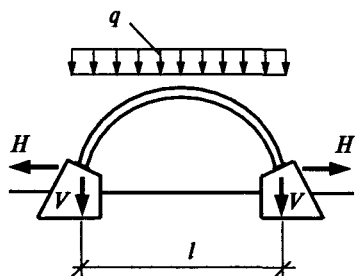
Передача нагрузки от арки на фундаменты:
